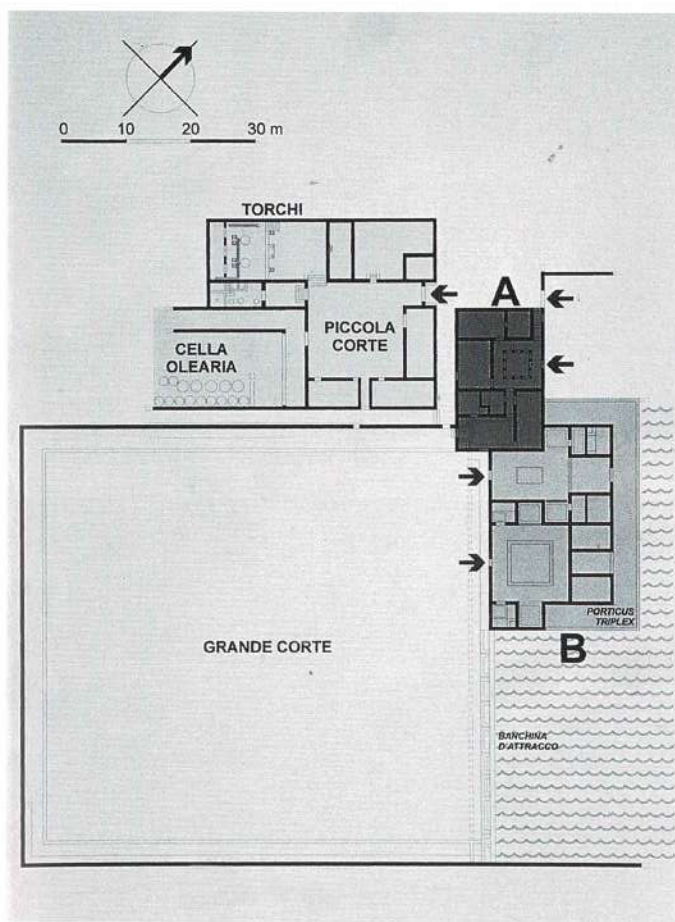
Varignano Vecchio (SP). Planimetria della Fase I di età sillana.
